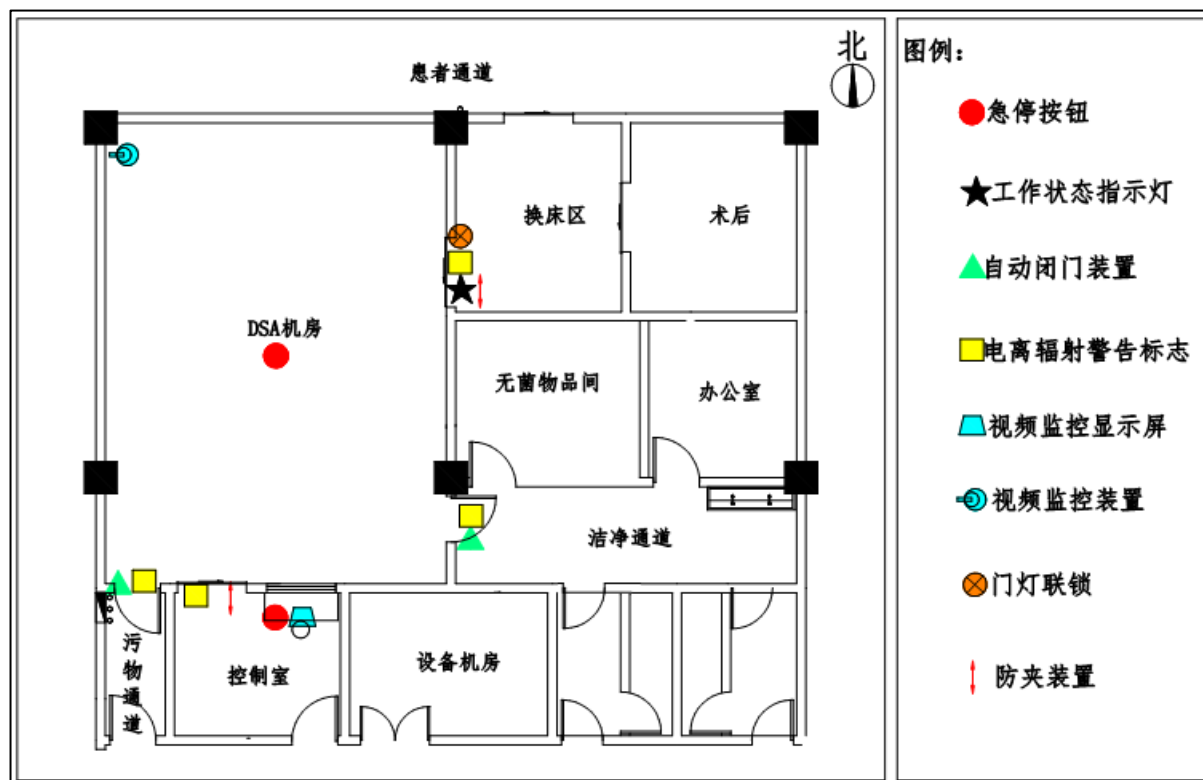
DSA 机房辐射防护与安全设施布置示意图
